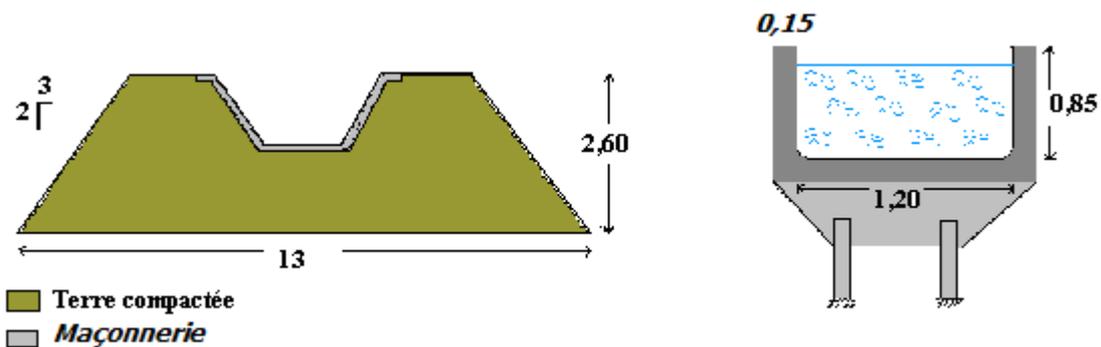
Coupes transversales des options sur le canal secondaire S2
